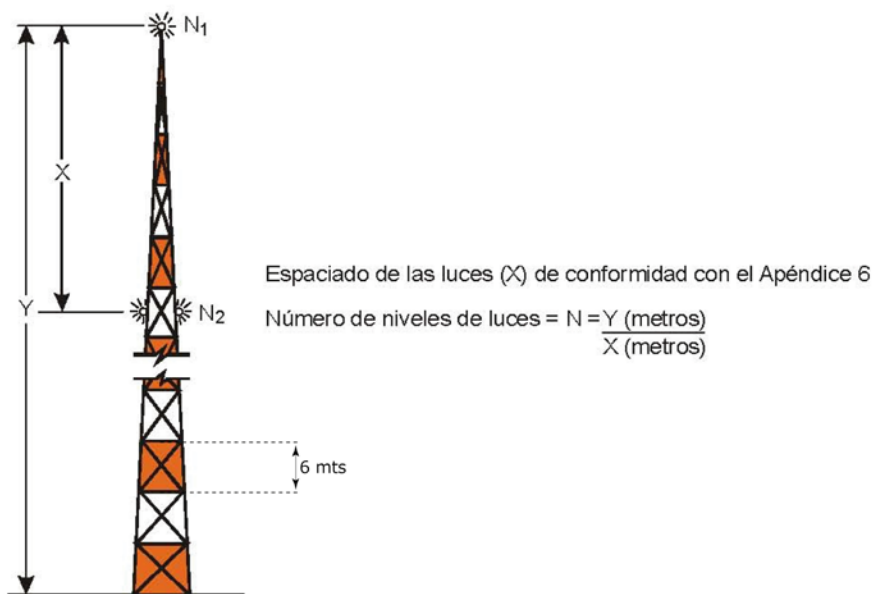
Ejemplos de señalamiento e iluminación de estructuras elevadas
